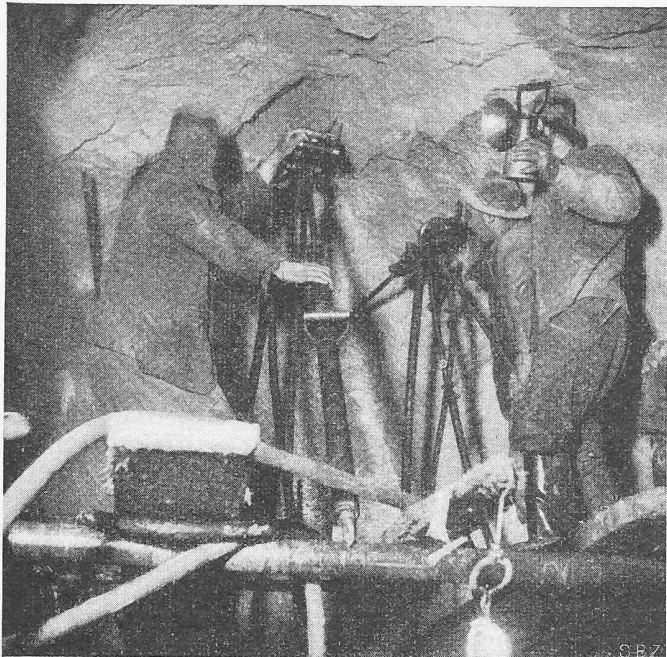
Stollenbau; Bohrmaschinen auf Bohrknechten und Spanssäulen
